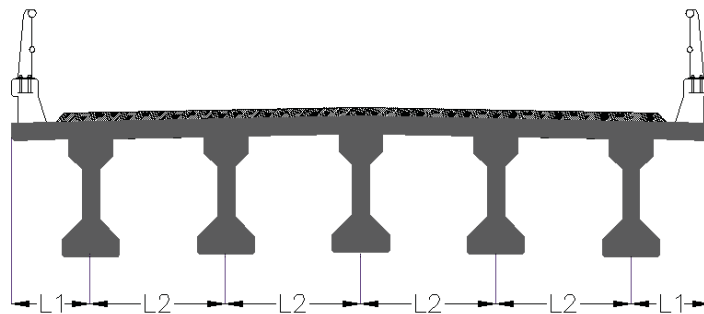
Sección transversal tipo de una losa apoyada sobre traveses tipo AASHTO
